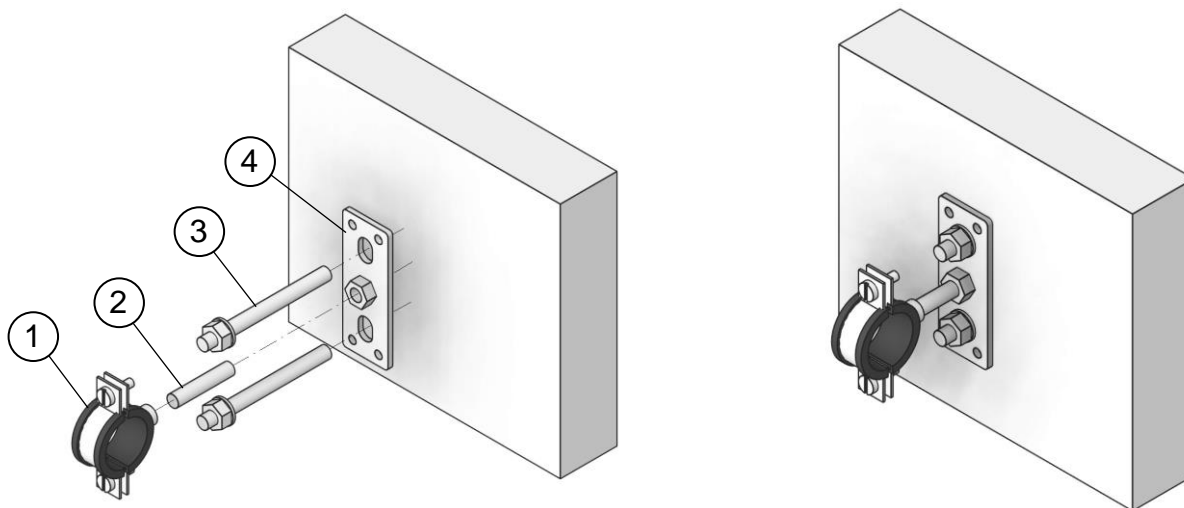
Анкерное крепление к стене при помощи EFP M8.
